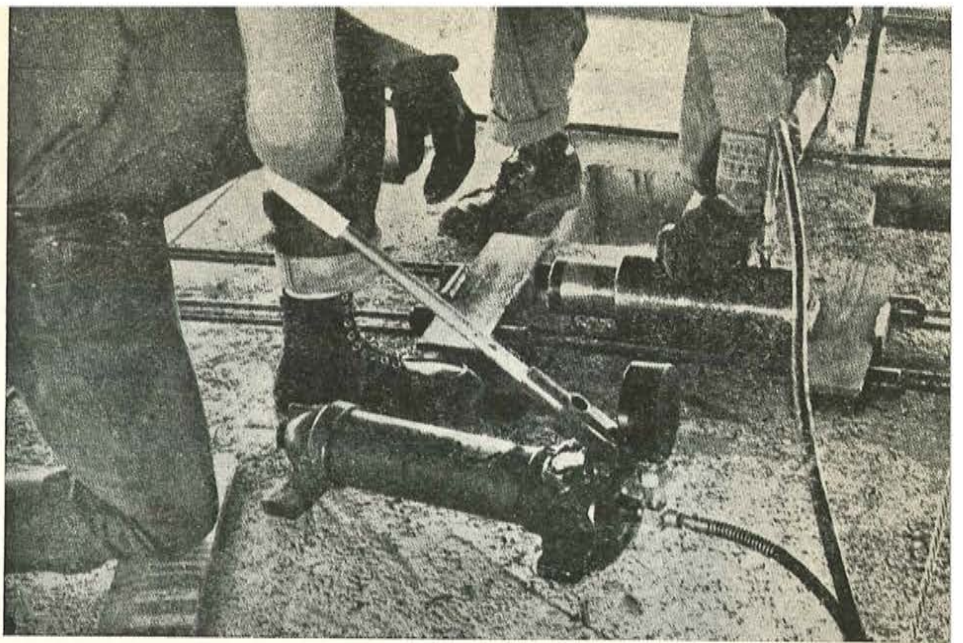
Construcción de las losas de los forjados en voladizo. Se han distanciado convenientemente los cables de pretensado para absorber mejor la excentricidad de las cargas.
